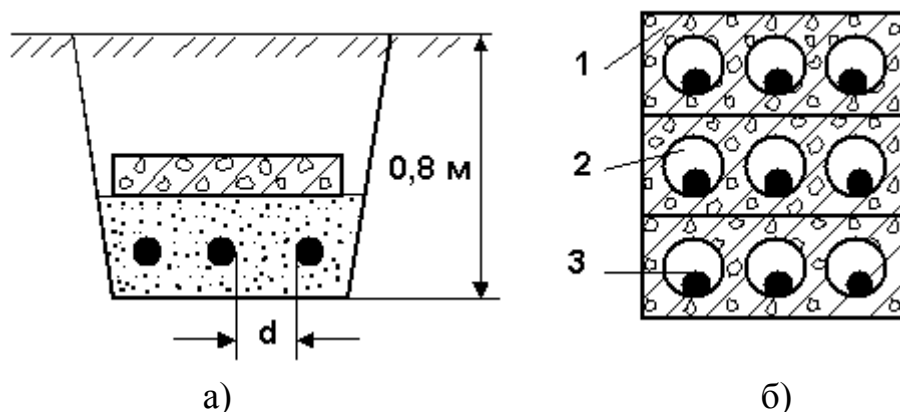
Эскиз прокладки кабелей в земляной траншее (а) и бетонном блоке (б)
